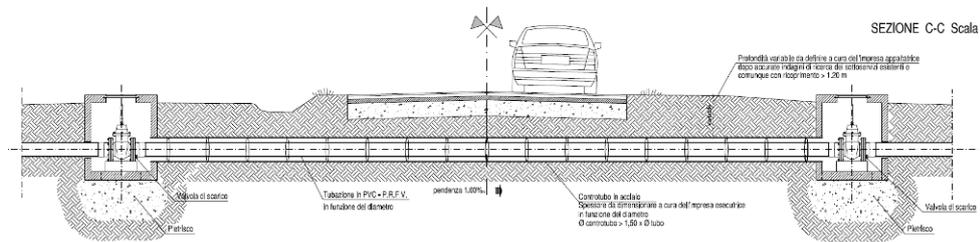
Sezione tipo delle soluzioni di sottopasso stradale. - Allegato B.7.6.
